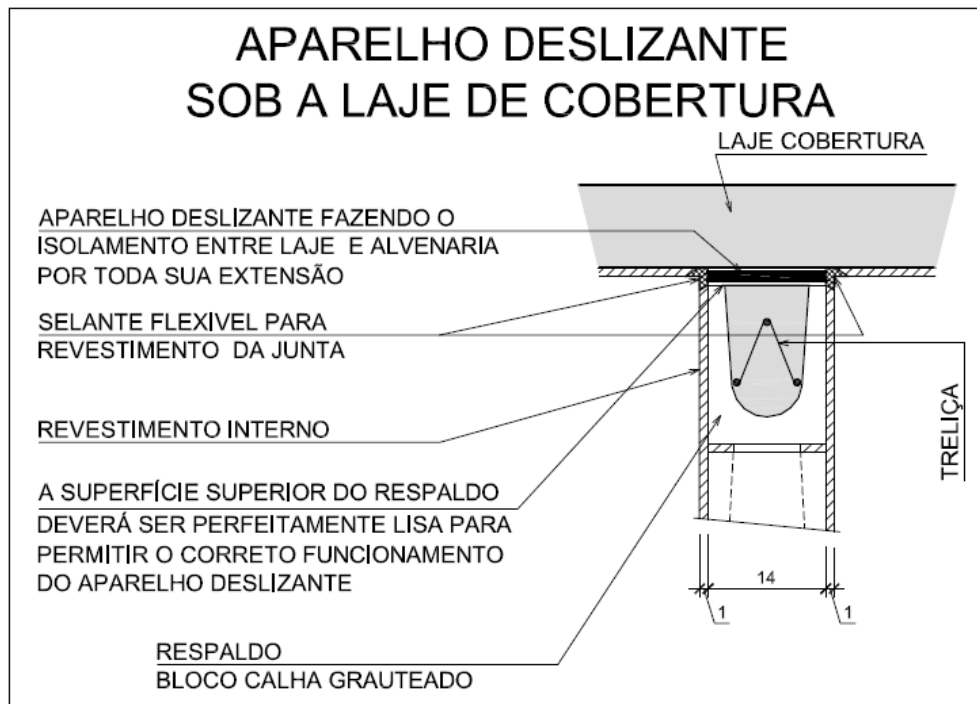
detalhamento do aparelho deslizante entre laje de cobertura e a parede interna da edificação
